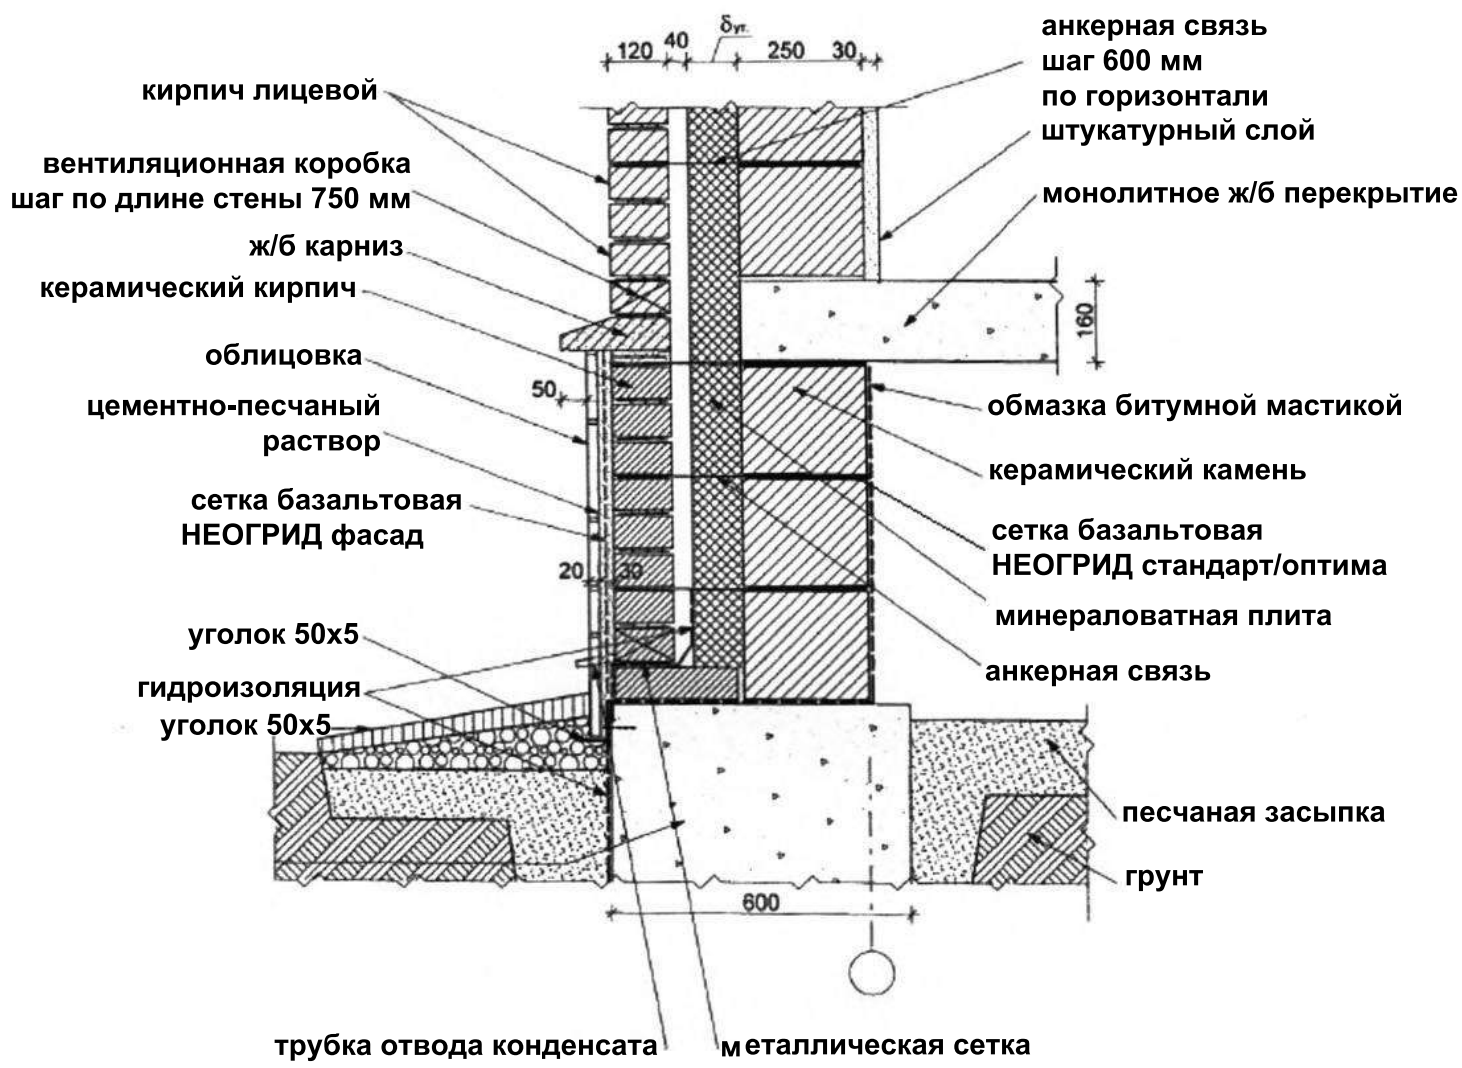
Конструкция двухслойной стены с наружным теплоизоляционным слоем в зоне цоколя для районов с сейсмичностью 7 баллов
